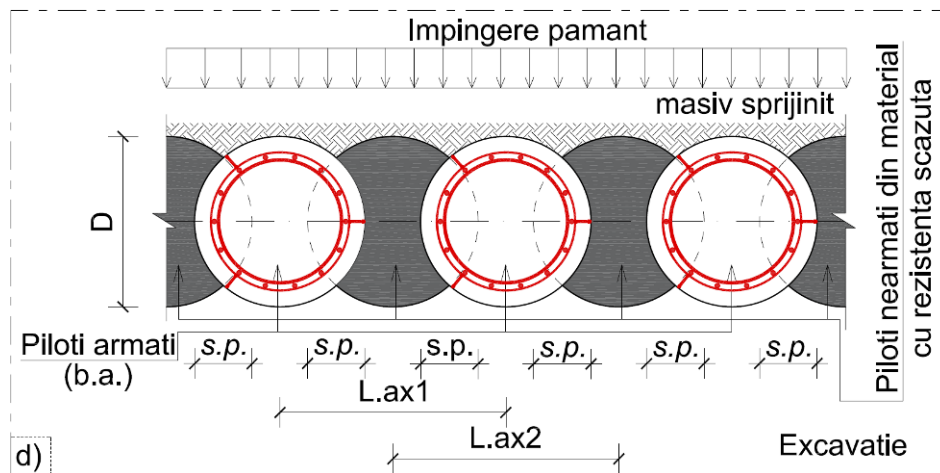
Perete de sprijin din piloți secanți – piloți primari de etanșare.
